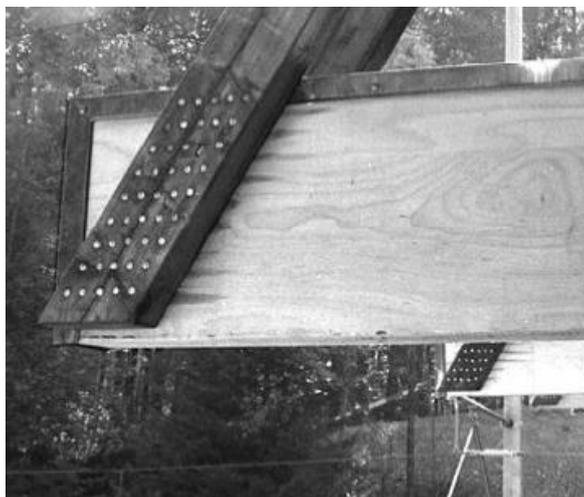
Drainage / “Drenaggio” – nel presente caso la soluzione a livello di particolare costruttivo è estremamente semplice: montante di balaustra distanziato dalla trave principale, evitando contestualmente superfici di contatto (fonte: archivio storico Università di Trento)
